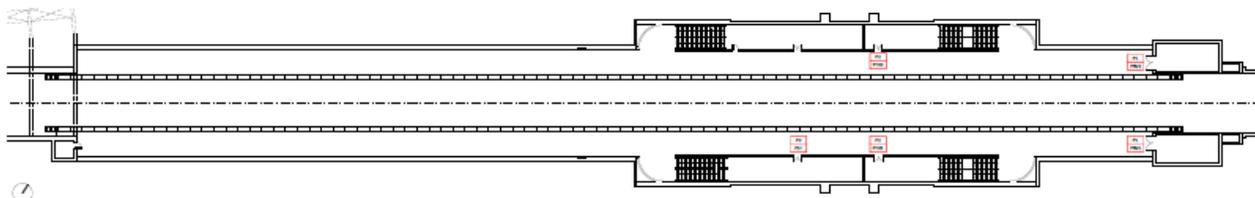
TABLEROS VÍA 2
